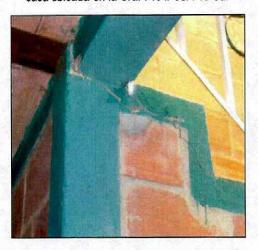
Desplazamiento en el muro de la habitación principal en la Cra. 71J # 68A-11 Sur
